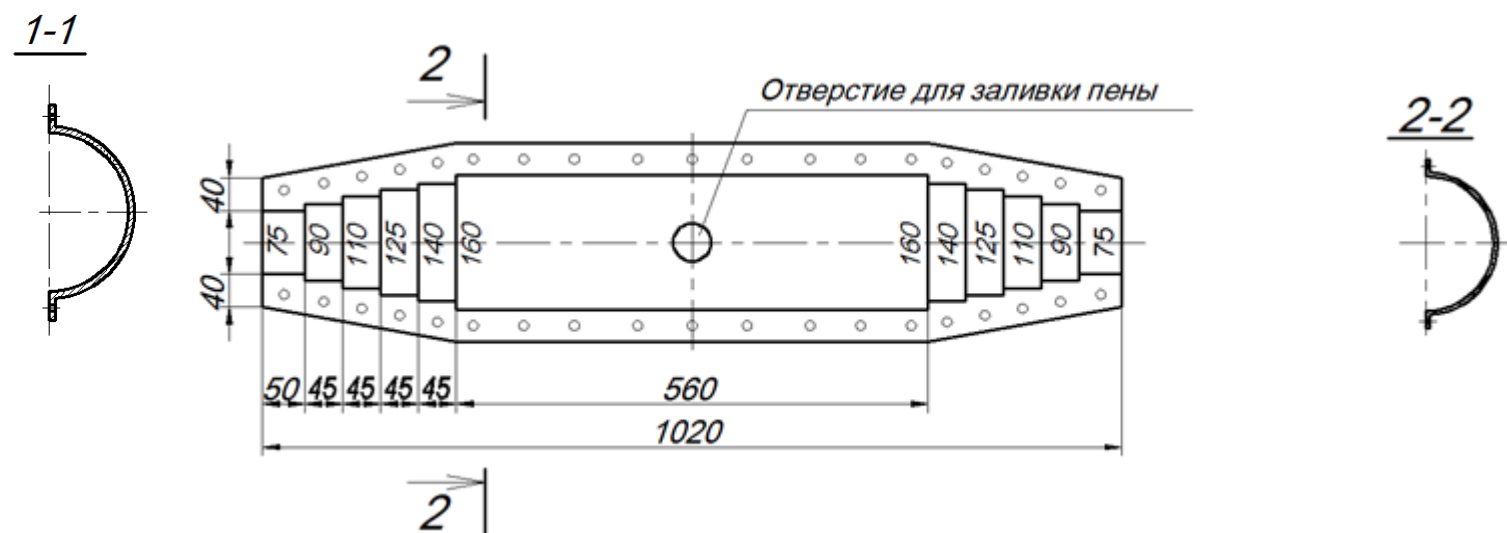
Кожух для изоляции линейного стыка, универсальный
